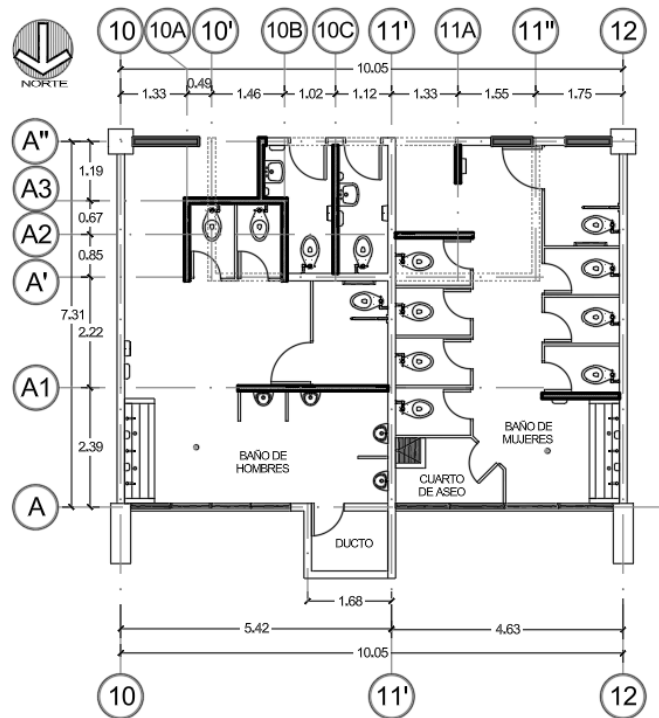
Planta Arquitectónica Módulos Sanitarios, Segundo Nivel
